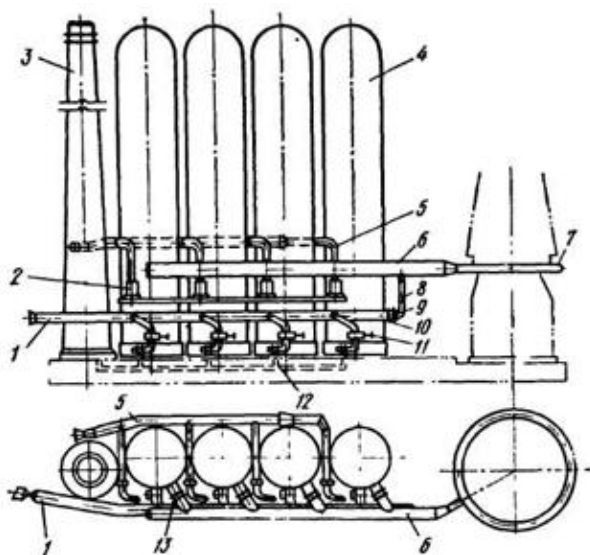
Схема расположения воздухонагревателей [12]:
